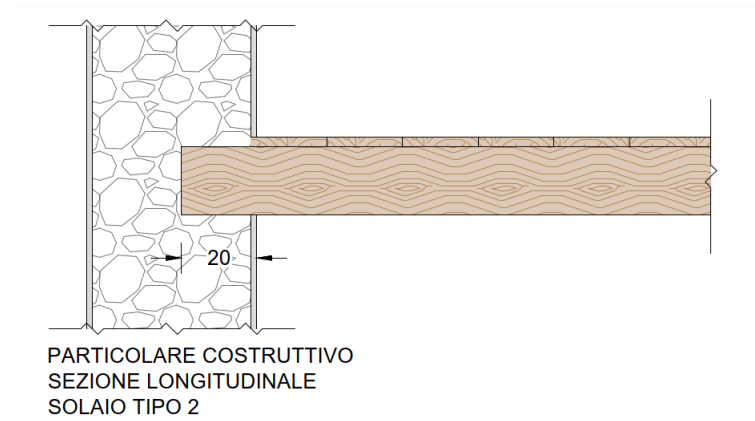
Particolare costruttivo Solaio tipologia 2 - Sezione longitudinale
